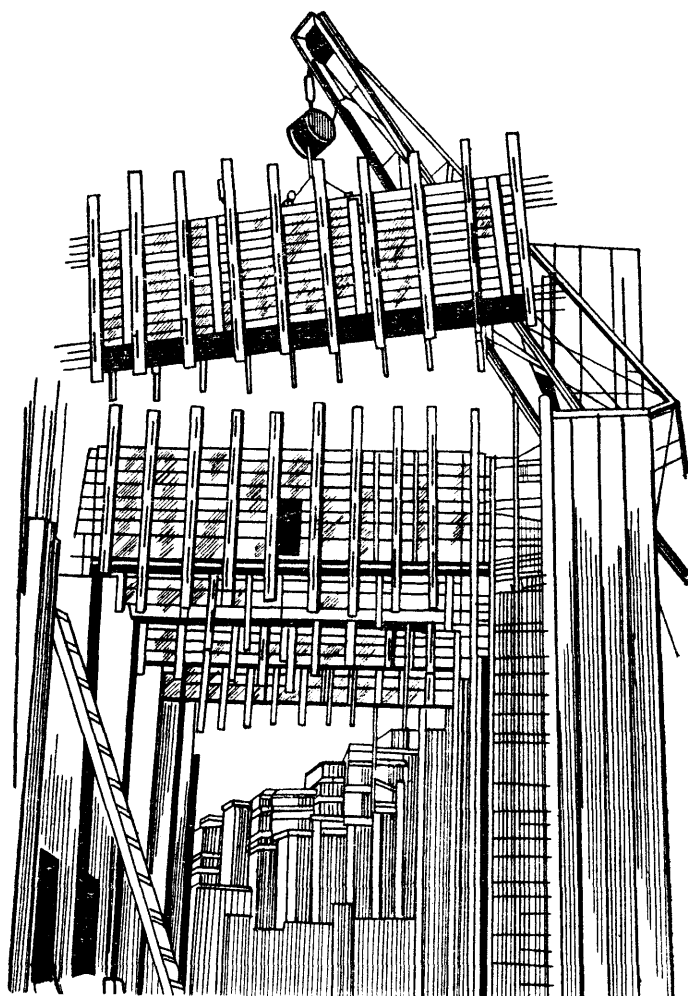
Установка краном опалубки прогона с прикрепленной к опалубке арматурой.
